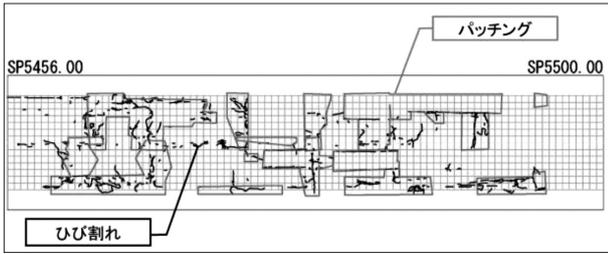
路面性状測定車より作成したひび割れ展開図
